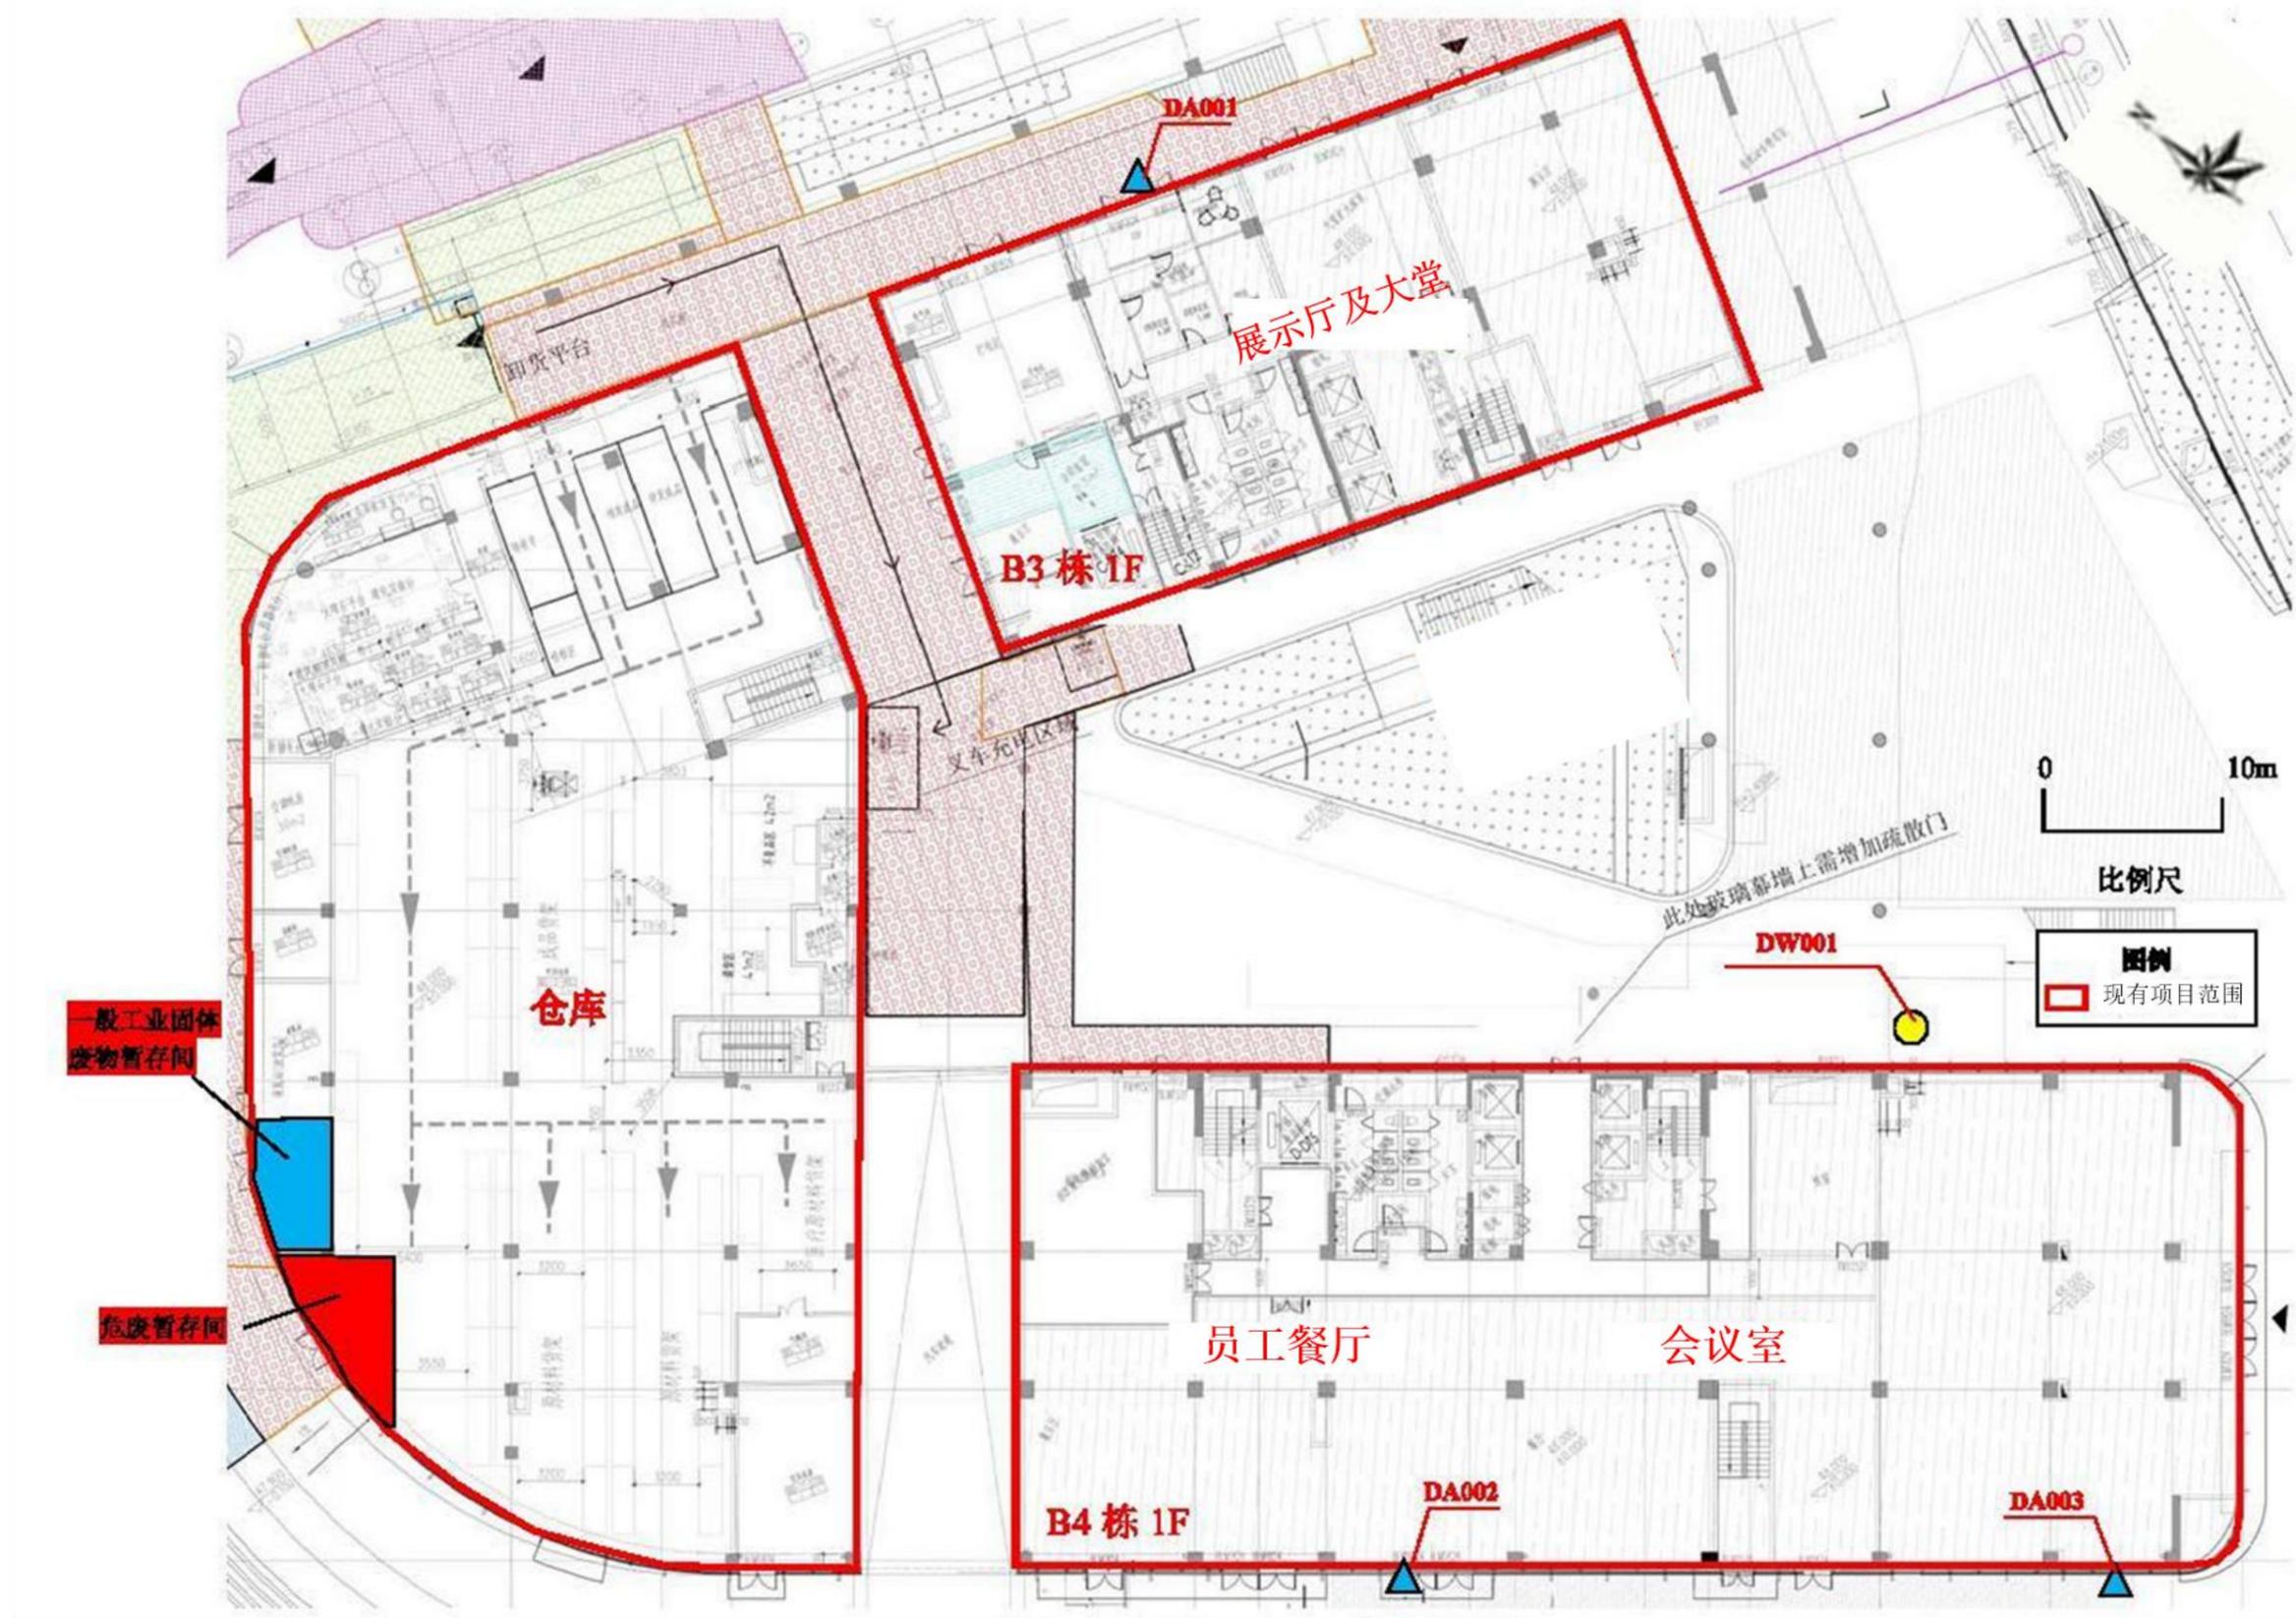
现有项目总平面布置图 (含 B3、B4 栋一层平面布置图)
